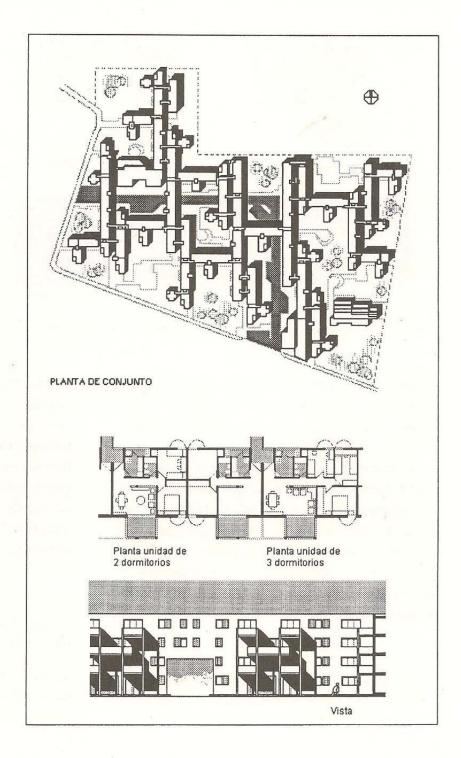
Conjunto La Matanza, del estudio Staff (Bielus, Goldemberg y Wainstein-Krasuk). Planta de conjunto, plantas de las unidades de 2 y 3 dormitorios, y elevación de un sector.
